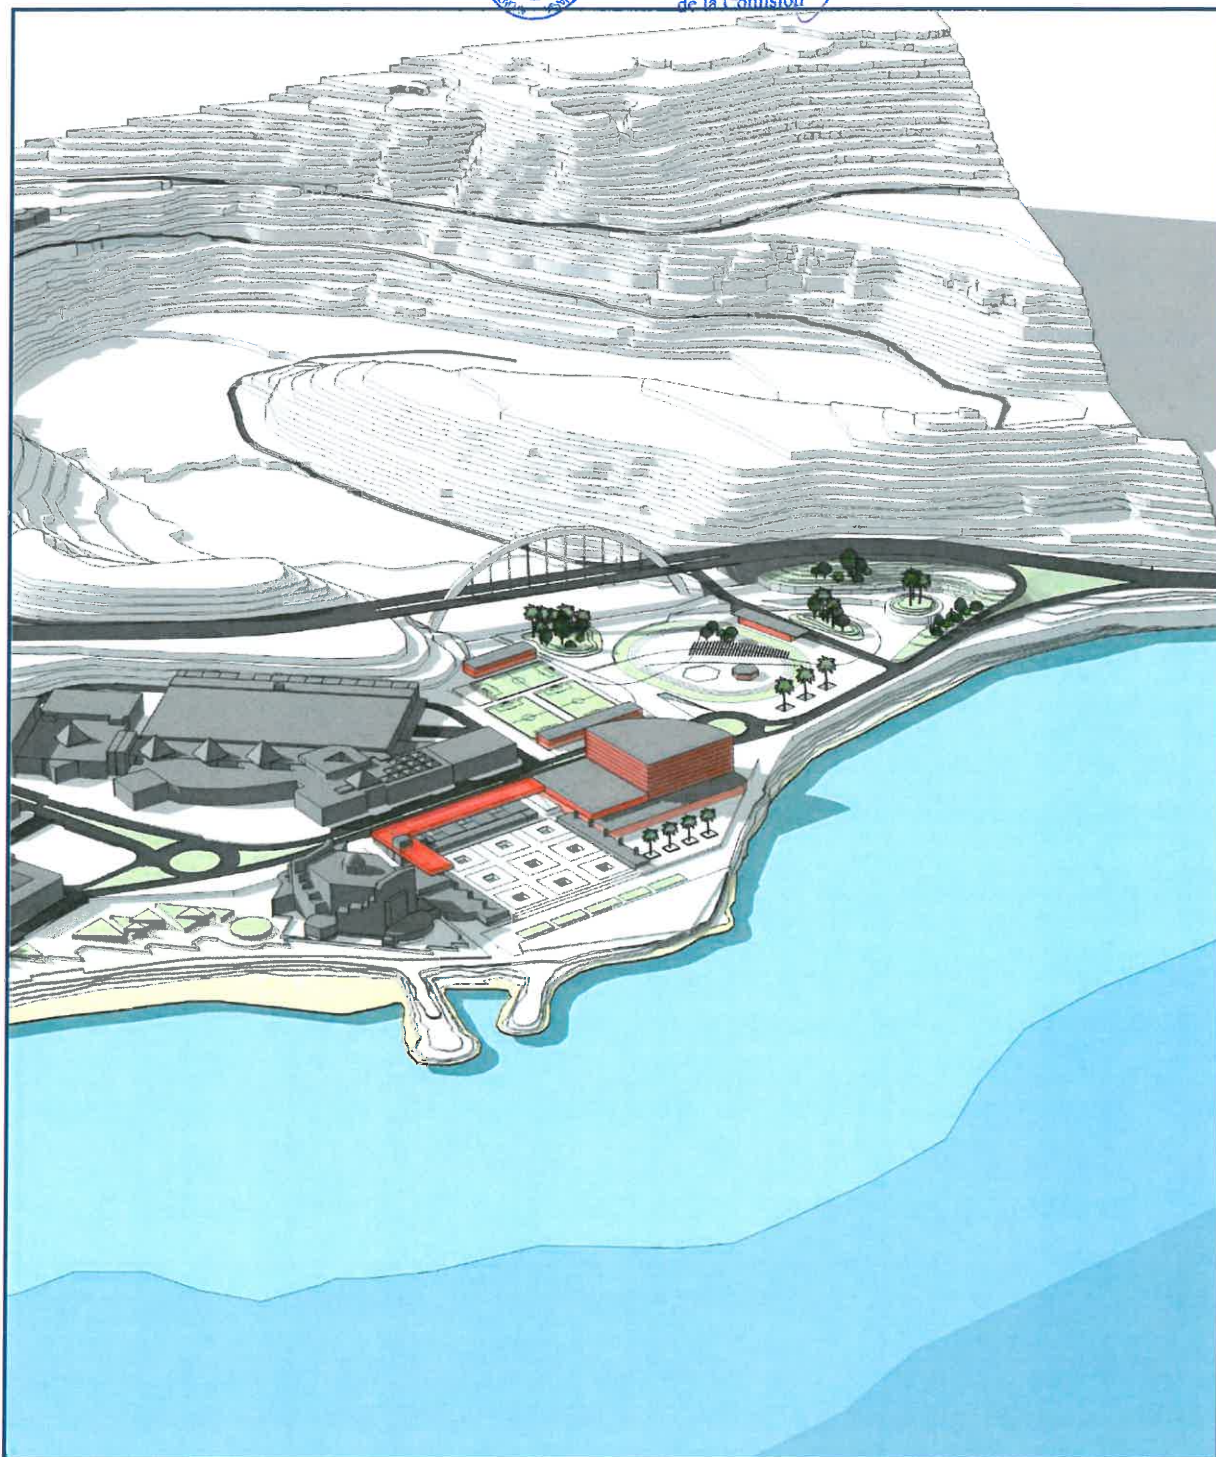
Alternativa 1. Imagen de la volumetría 1. Fuente: elaboración propia
